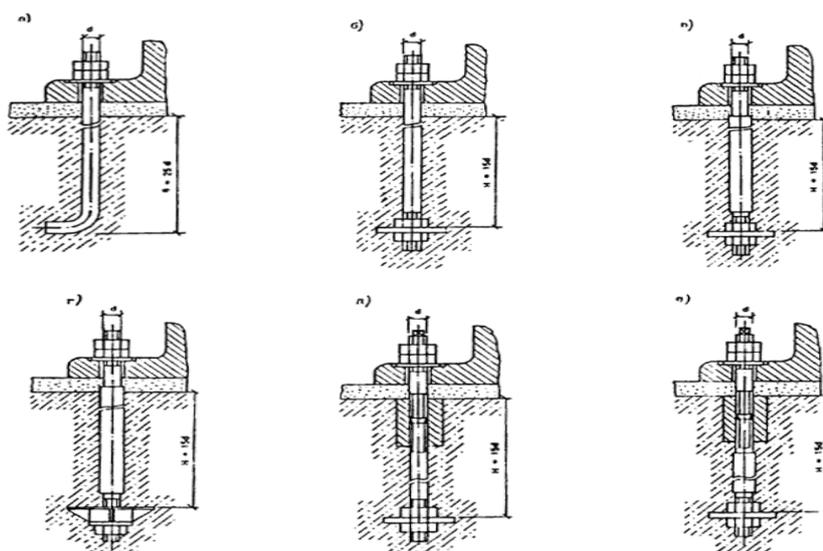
Болты, устанавливаемые в фундаменты до бетонирования:
